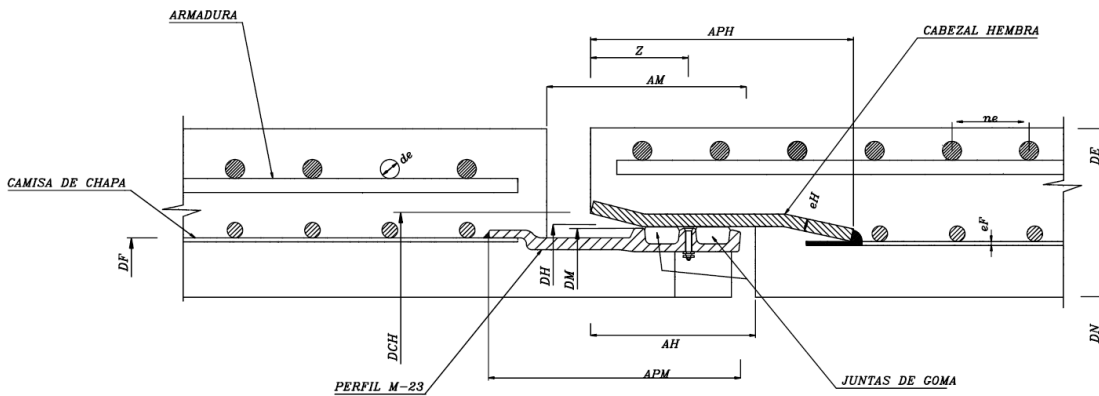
Junta elástica doble en tubería de hormigón armado con camisa de chapa.
